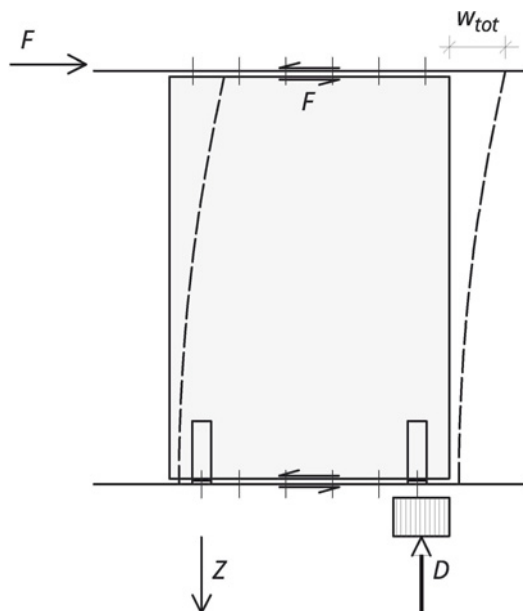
Parete di irrigidimento con collegamento alla soletta e al suolo
